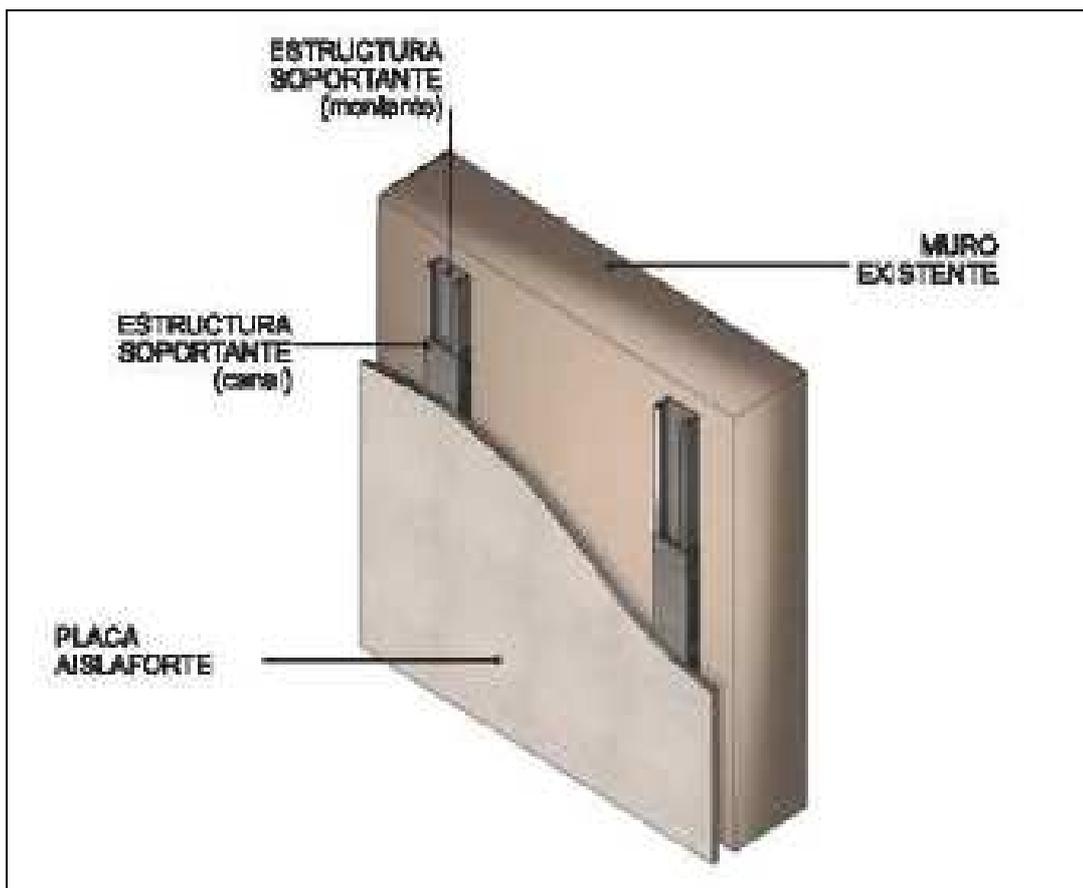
Componentes de sistema de fachada ventilada con revestimiento exterior de placa aislaforte a base de cemento y malla de fibra de vidrio.
